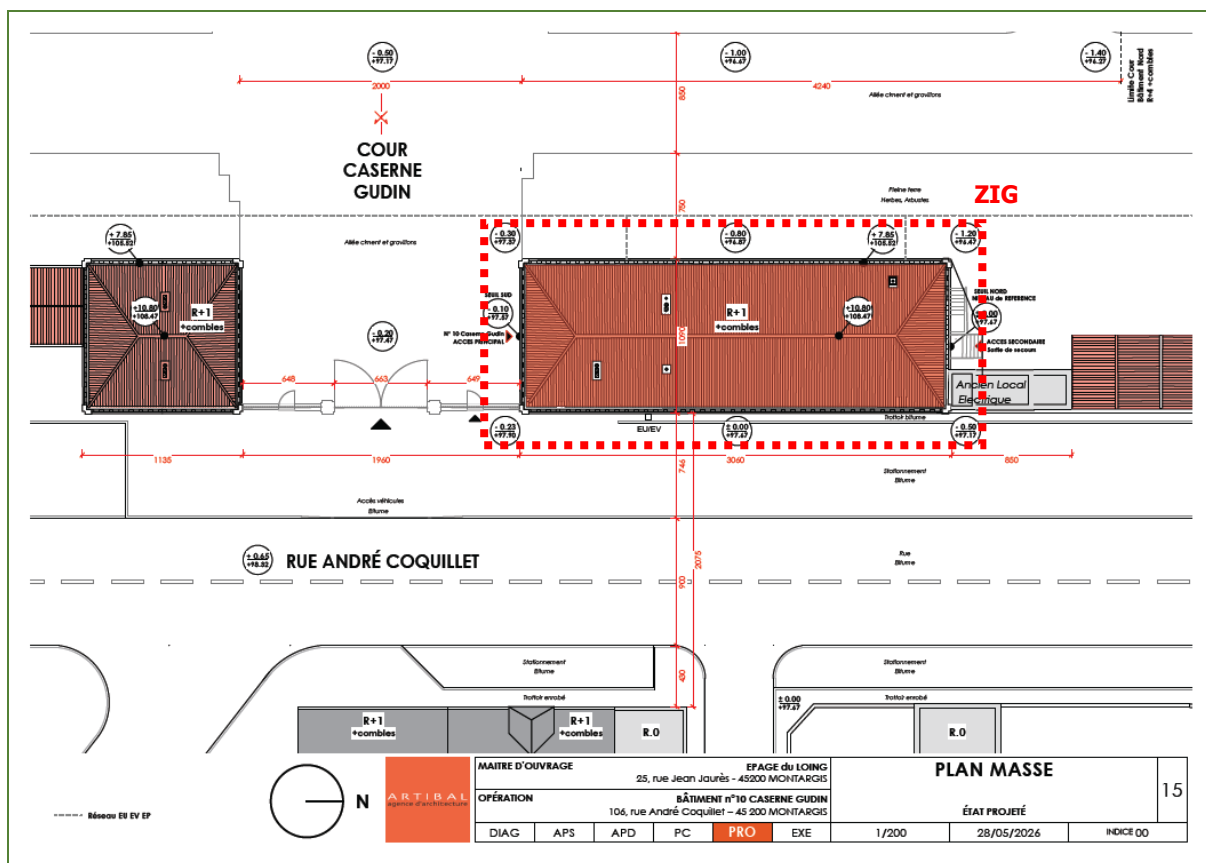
Plan de ZIG sur le plan de masse du projet [2]
